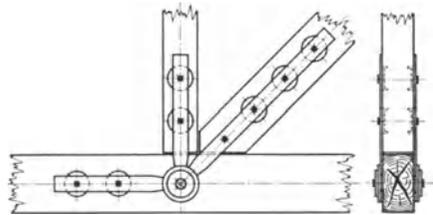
Stahlgelenkverbindung der Siemens-Bauunion.
